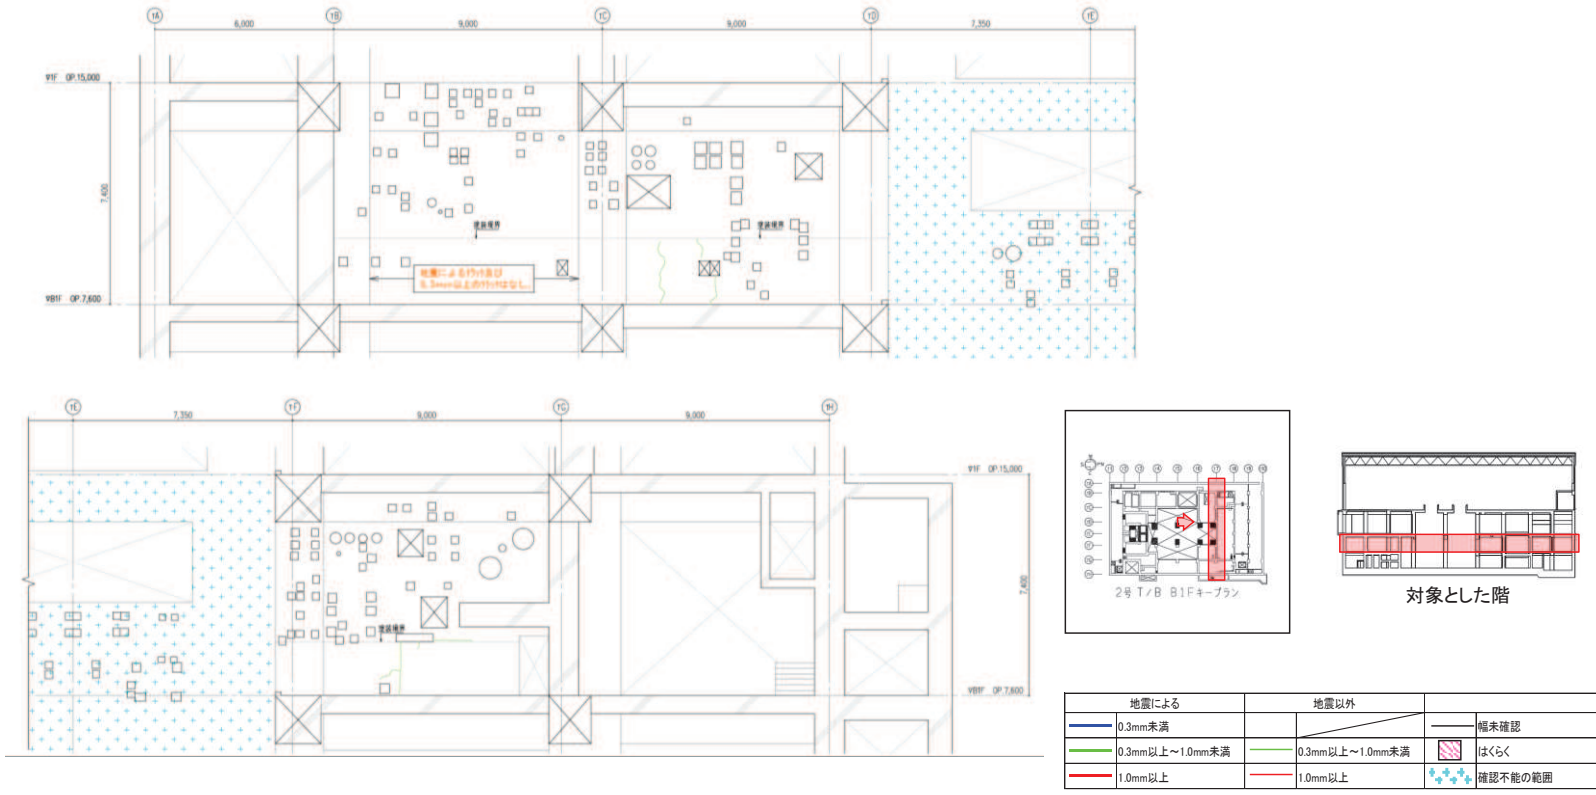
タービン建屋のひび割れ分布 耐震壁 (23) 地下 1 階 T7 通り
